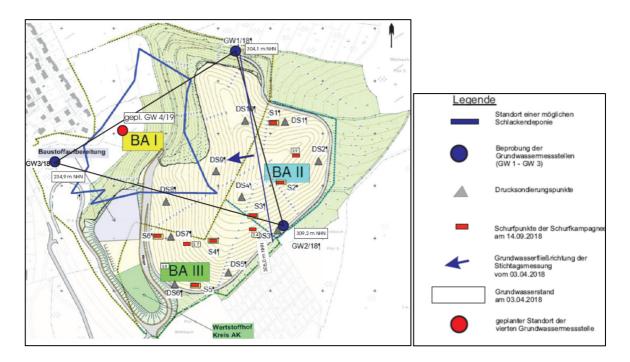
Lageplan zur Grundwasserfließrichtung mittels Erstellung eines hydrologischen Dreieckes
